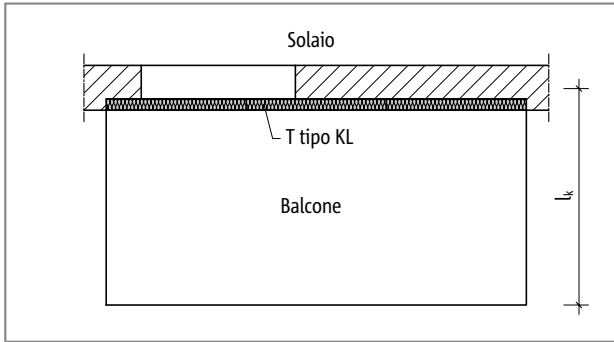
Schöck Isokorb® T tipo KL, balcone a sbalzo
